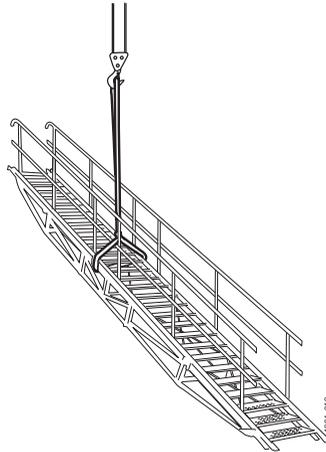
Positionnement du câble de levage à l'escalier et à la poutre
